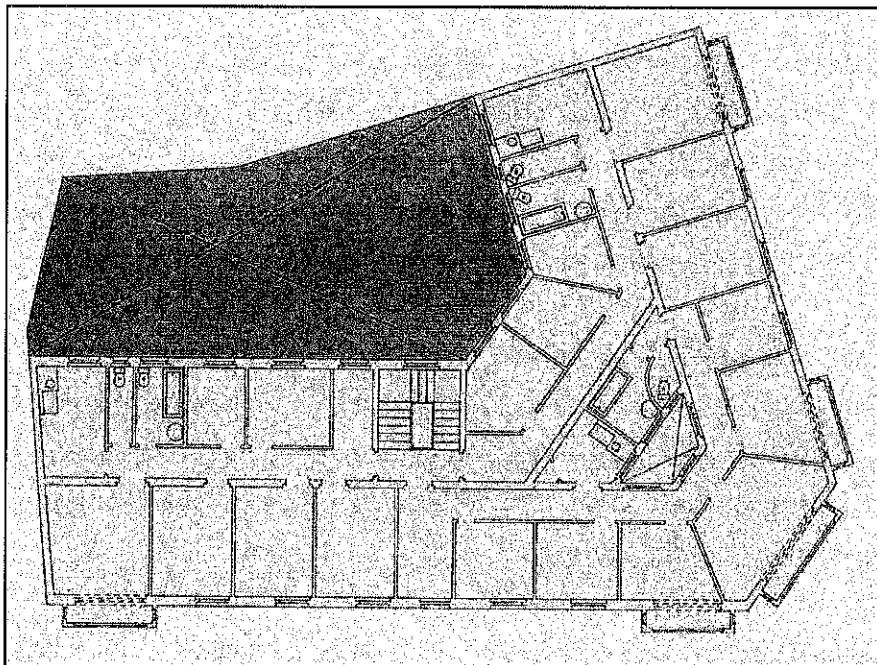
Planta tipo del inmueble (se señala en color la zona de patio donde se produce el incremento del volumen edificable)
